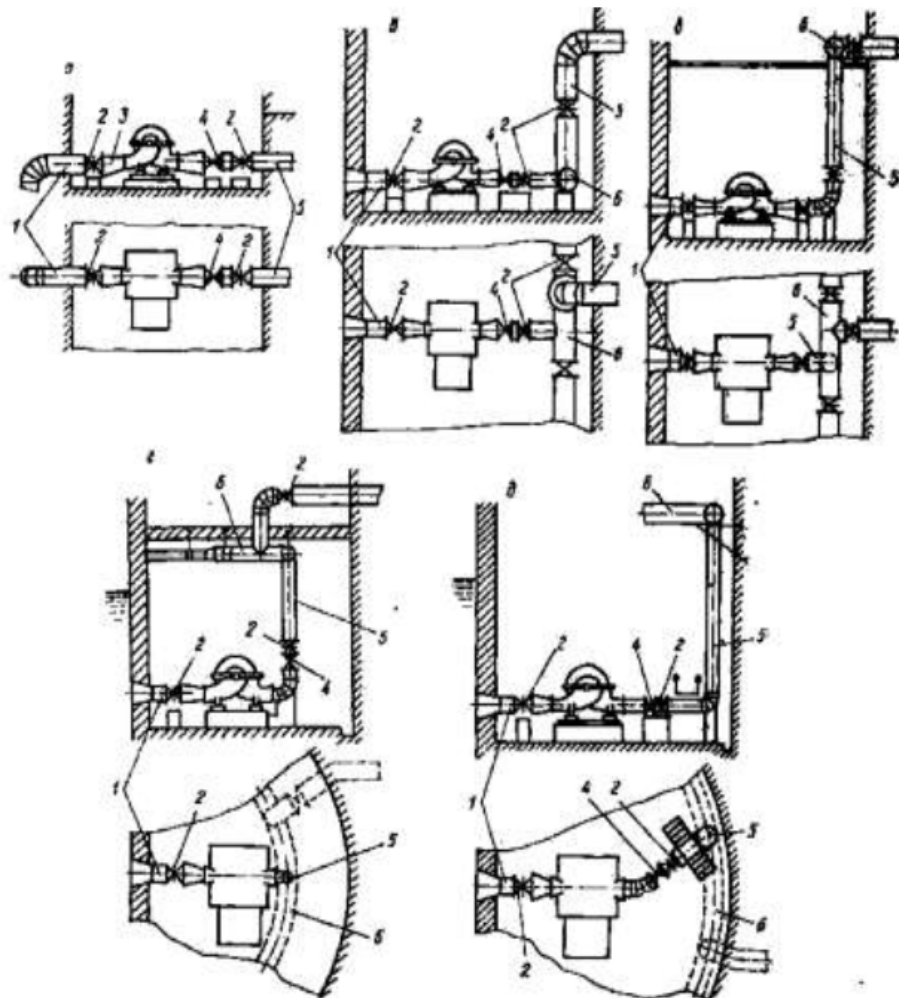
Схеми компонувань усмоктувальних і напірних трубопроводів насосних станцій першого підйому з насосами типу Д:
